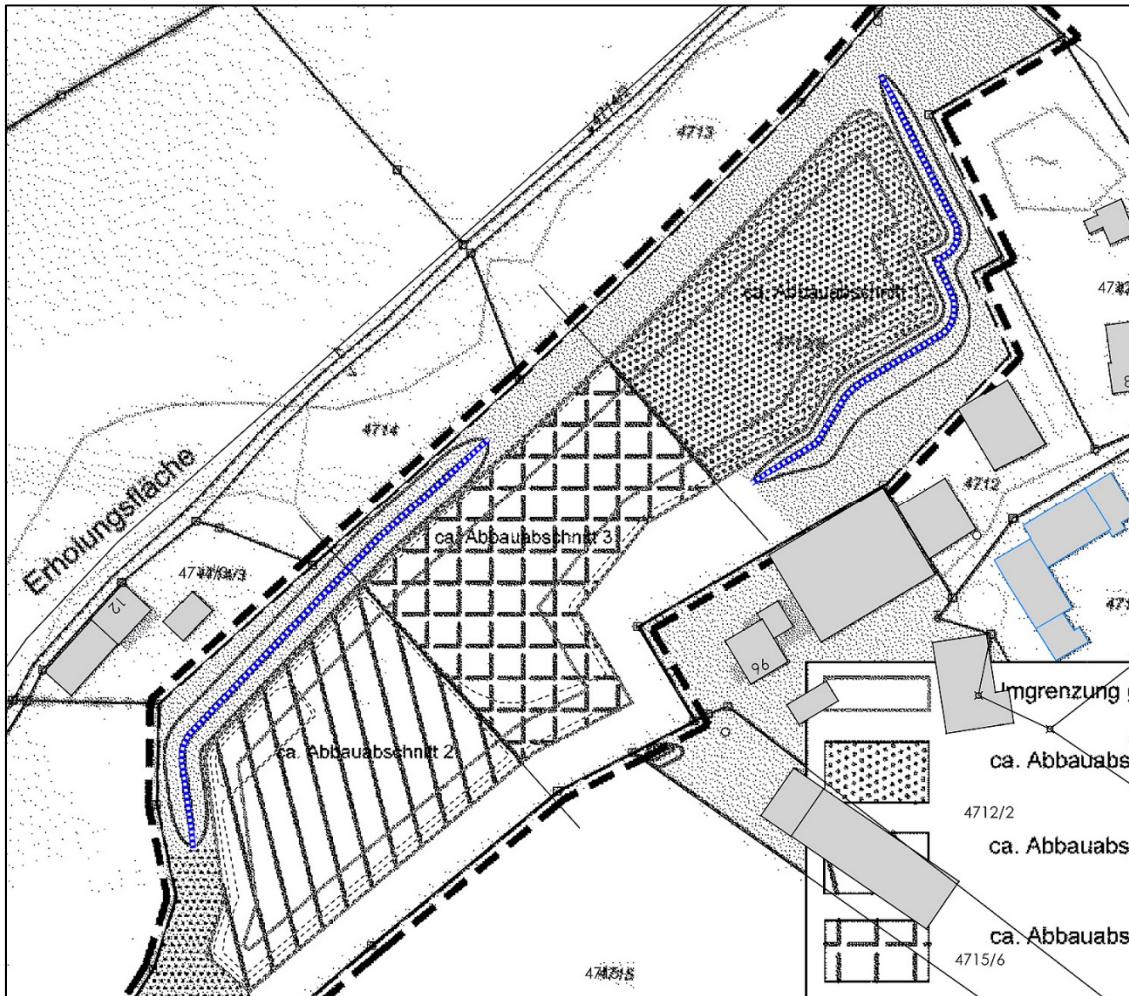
Lageplan mit Darstellung der beiden Wälle (blaue Linien)
